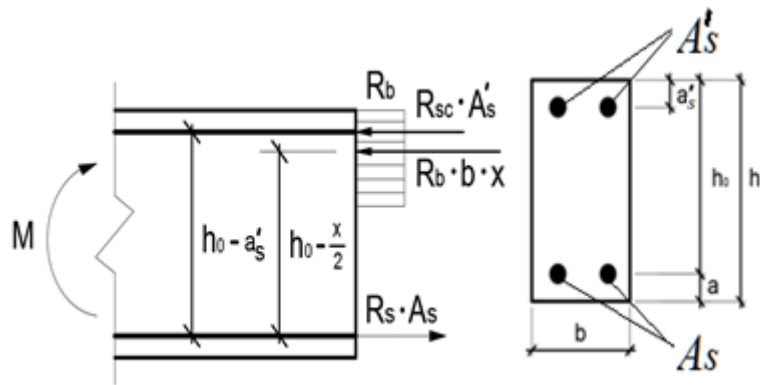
Схема усилий в изгибаемом элементе прямоугольного сечения с двойной рабочей арматурой
